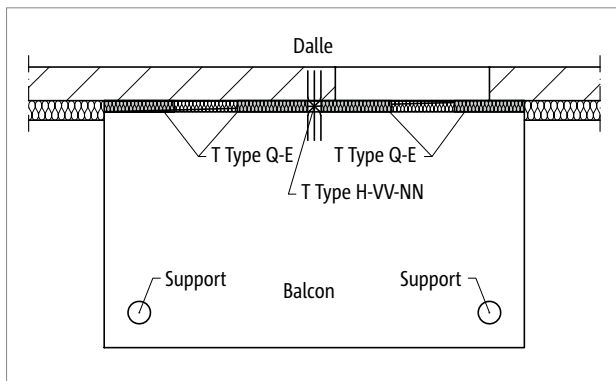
Schöck Isokorb® T Type H : Balcon avec appuis
